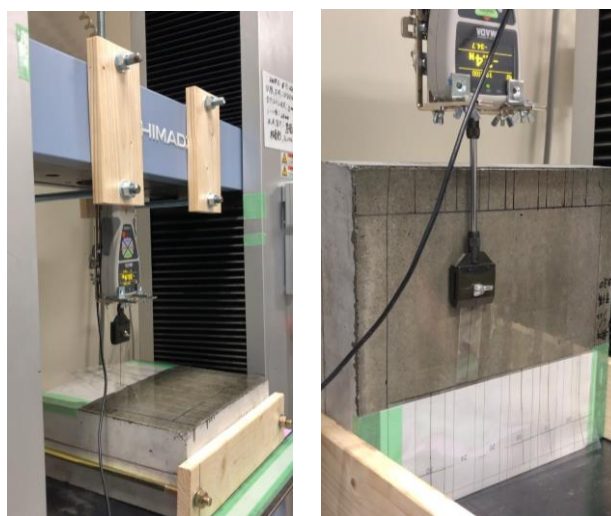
シート工の層構成 写真-2 粘着シートの貼付状況の例
